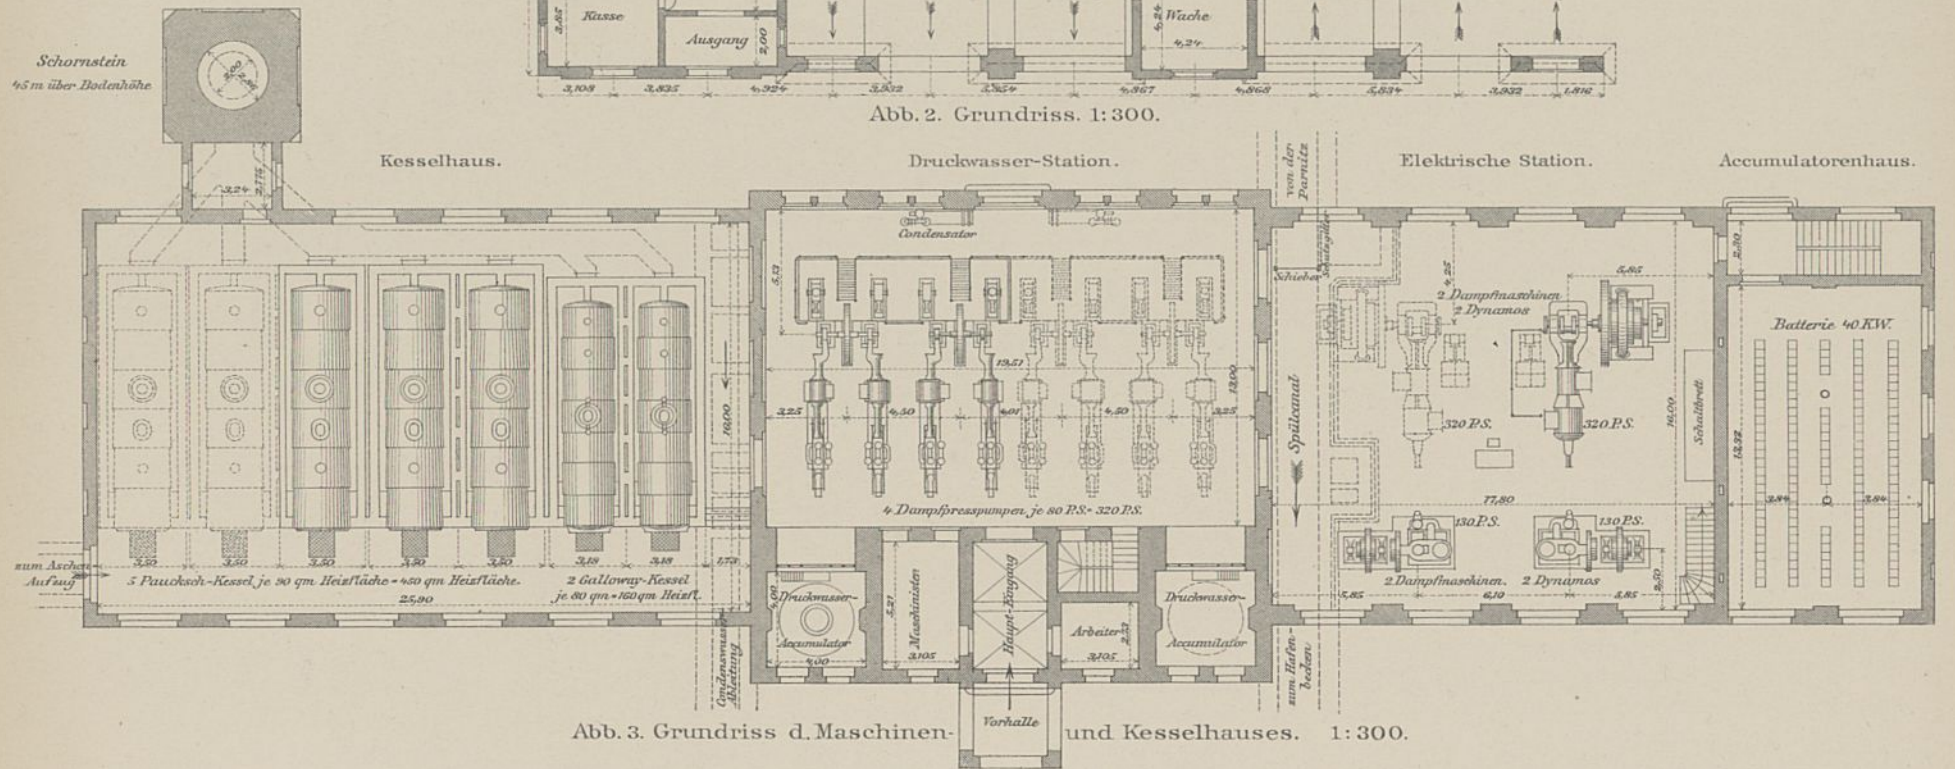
Grundriss d. Maschinen- und Kesselhauses. 1:300.
